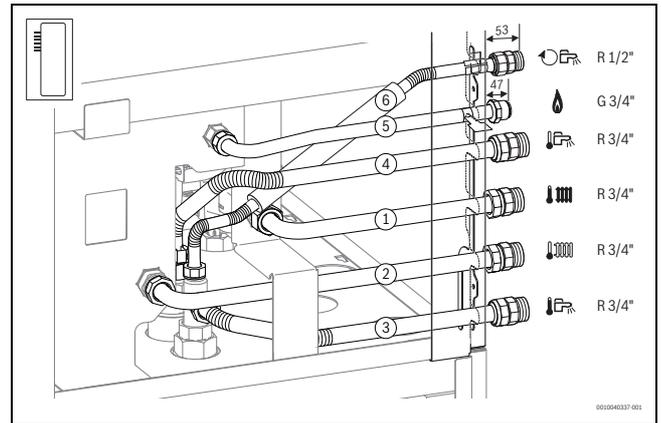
Vue côté arrière (dimensions en mm) : accessoire CS 10 FR-5300 monté sur le côté gauche
